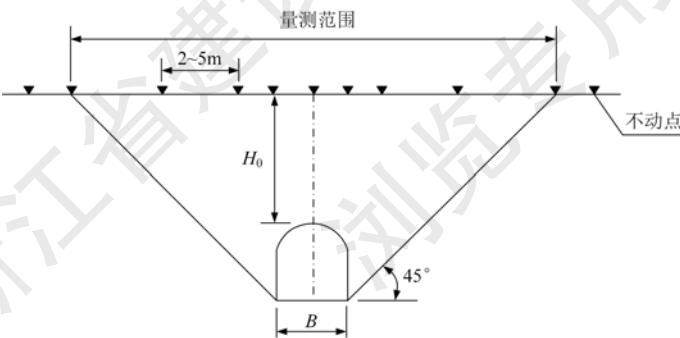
矿山法隧道地表沉降监测点横向布置示意图
